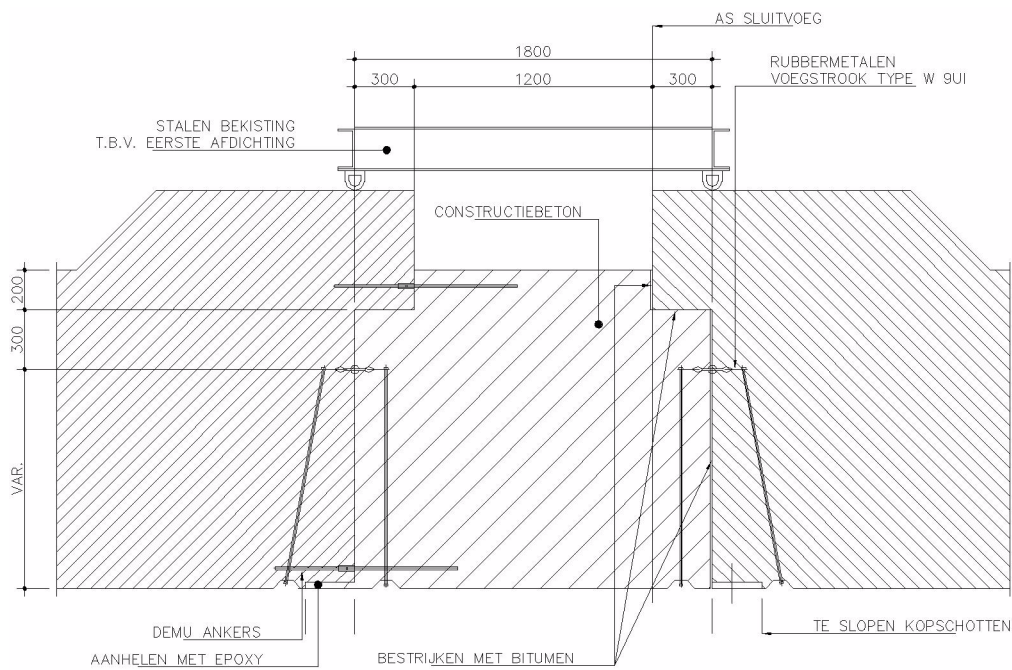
In te storten aanslag in het dak (5.2.9.10)
